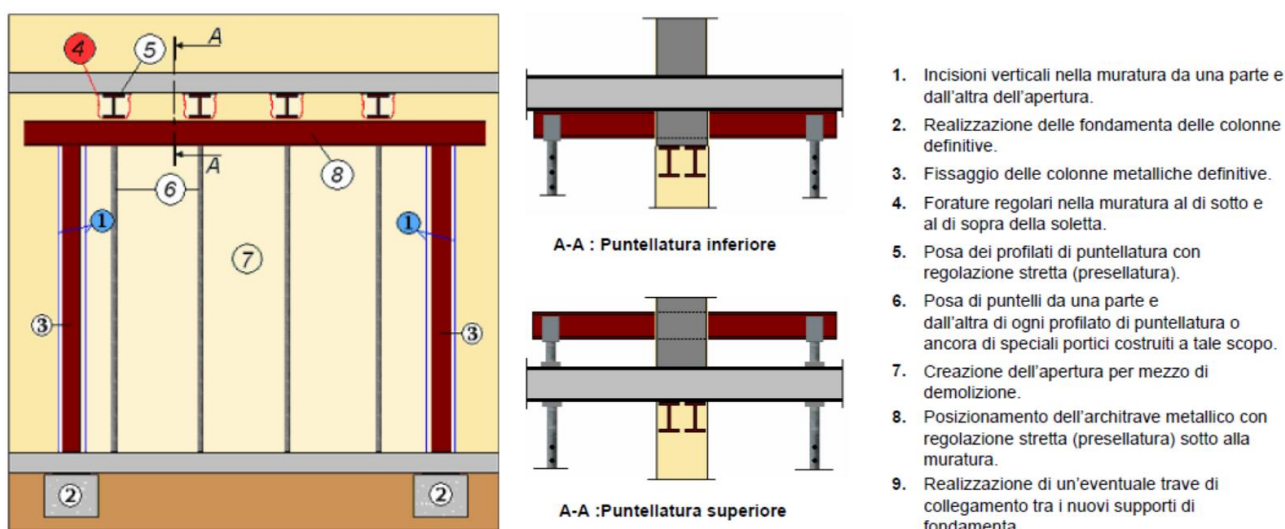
Creazione di un'apertura in muratura tramite puntellatura e consolidamento
